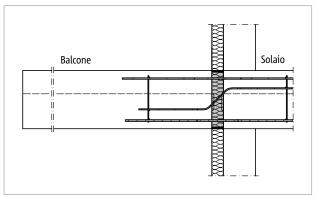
Schöck Isokorb® T tipo BP: balcone con travi a sbalzo
